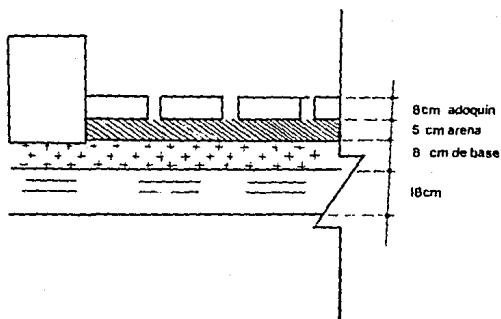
SECCION TRANSVERSAL TIPICA DEL PAVIMENTO PARA LA PLANTA LINGO BRONCE.
